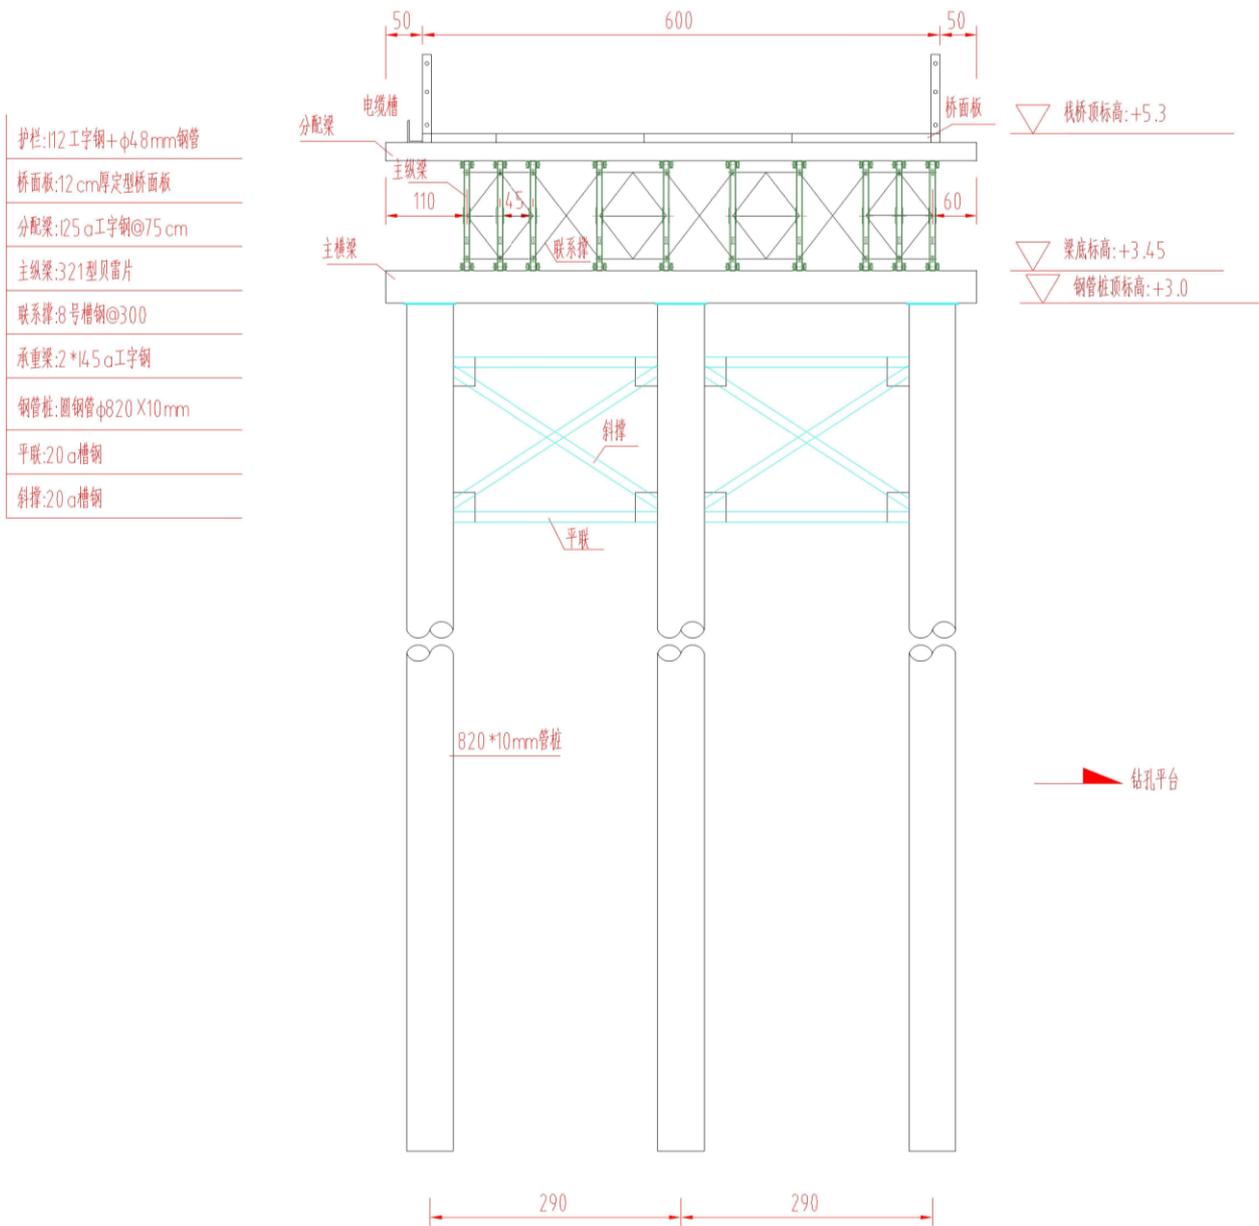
宝楼河大桥施工栈桥（主便道）横断面图
